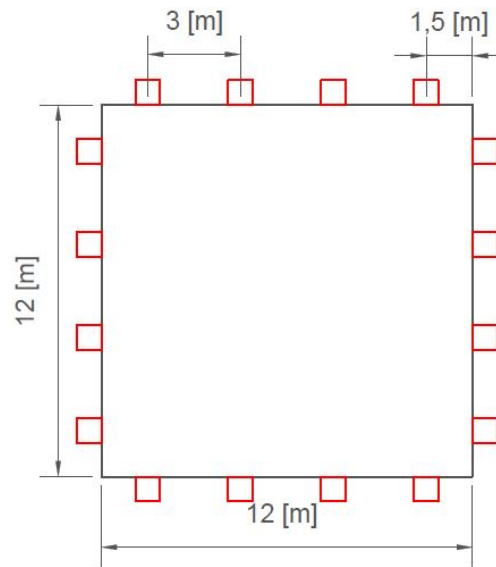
Vista en planta de excavación de área 144 [m²].
